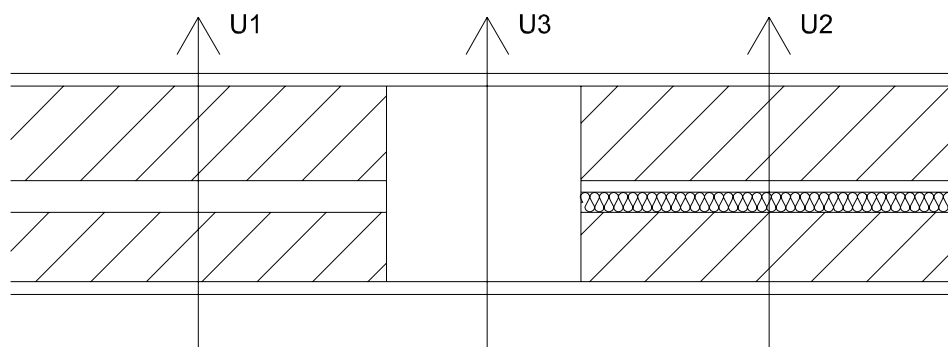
Ponte Térmica Plana – Pilar Intermédio
